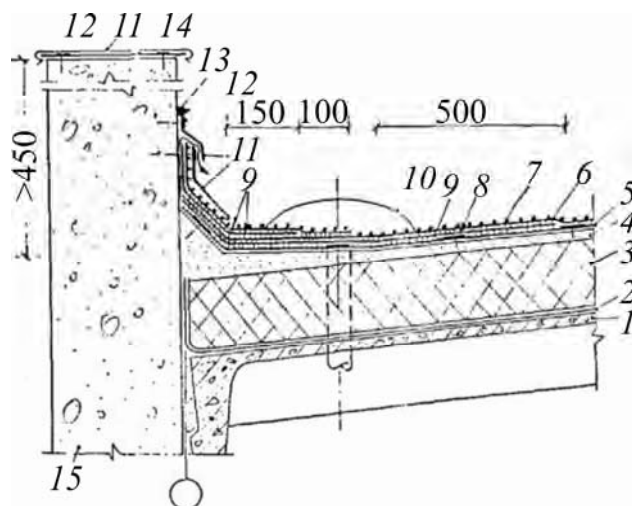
Примыкание кровли к парапету высотой более 450 мм: 1 — железобетонная плита покрытия; 2 — пароизоляция; 3 — теплоизоляция; 4 — выравнивающая стяжка; 5 — механически закрепляемый нижний слой основного кровельного ковра; 6 — верхний слой верхнего слоя кровельного ковра; 7 — крупнозернистая посыпка верхнего слоя ковра; 8 — шайбы с дюбелями; 9 — слой дополнительного кровельного ковра; 10 — воронка внутреннего водостока; 11 — оцинкованная кровельная сталь; 12 — дюбели; 13 — герметизирующая мастика; 14 — костыли 40 × 4 через 600 мм; 15 — стена
